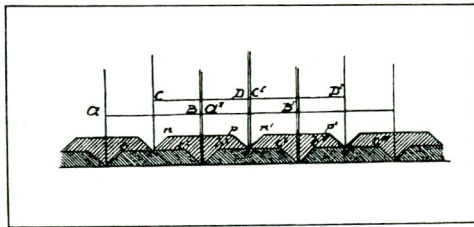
Wijze van betonfundering met behulp van de duikerklok.
